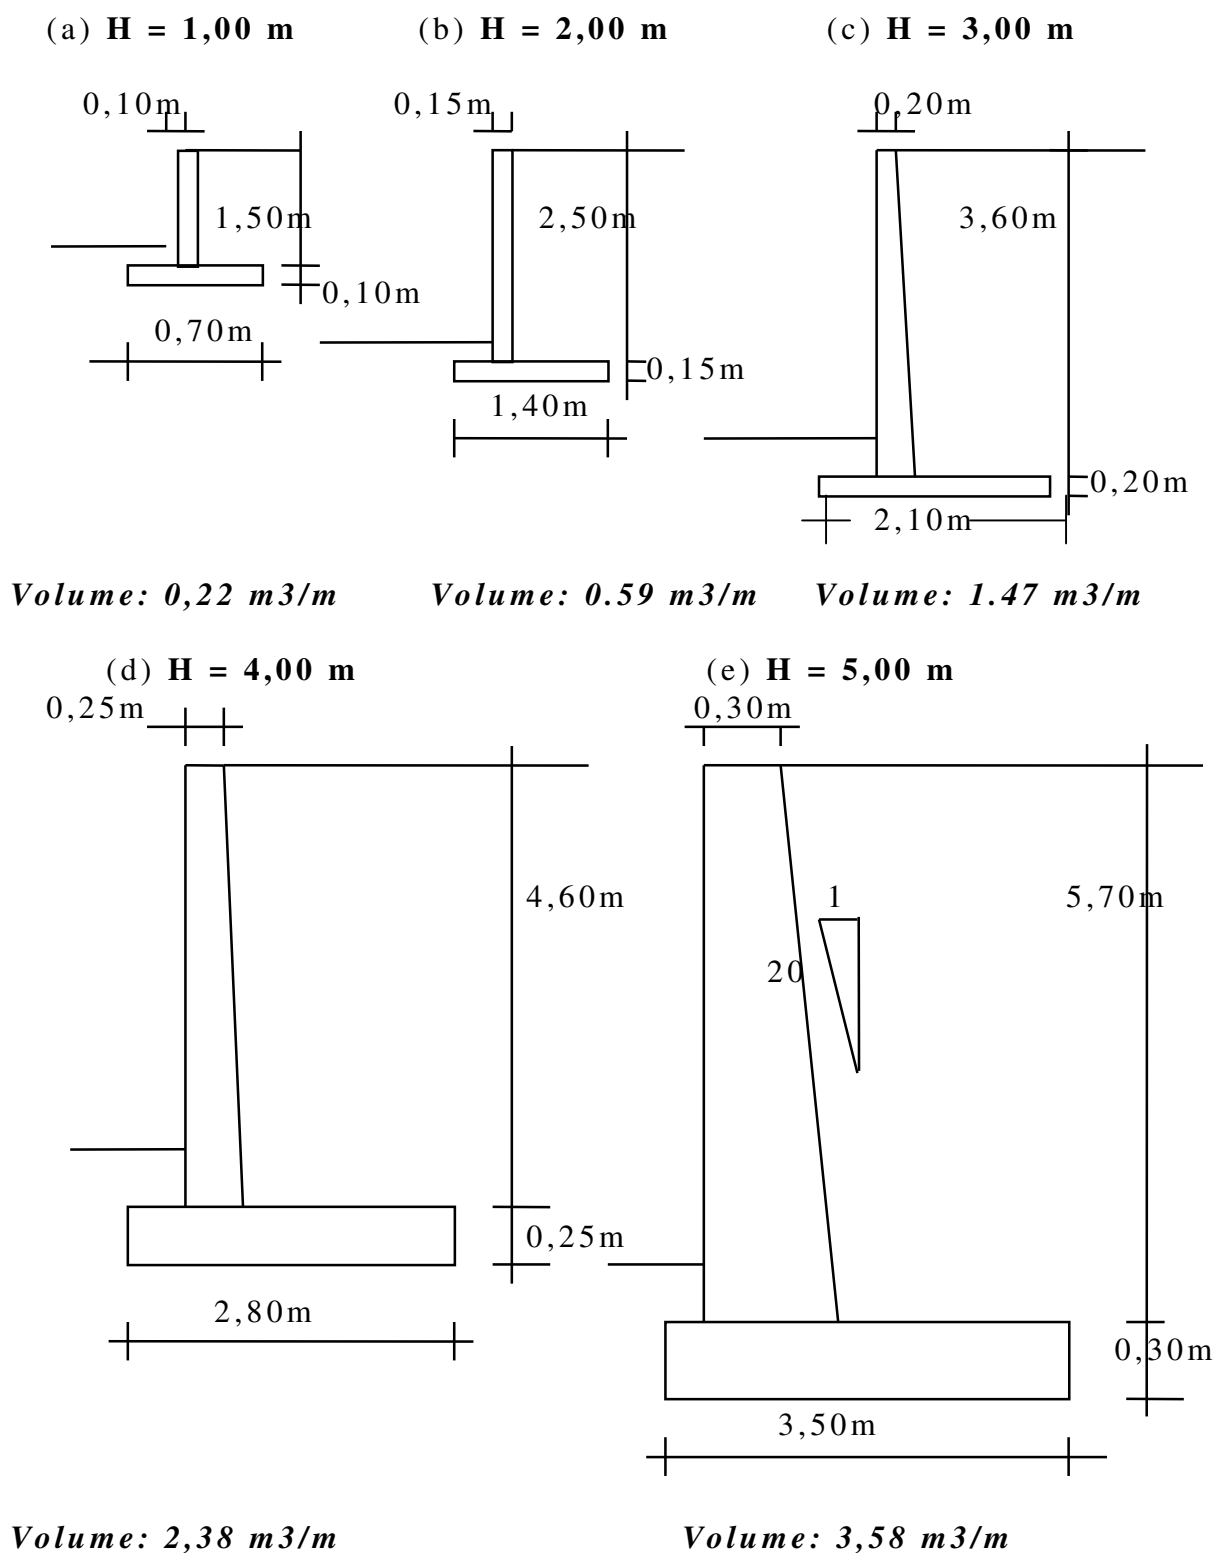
Seções típicas de muro de concreto armado para diversas alturas
